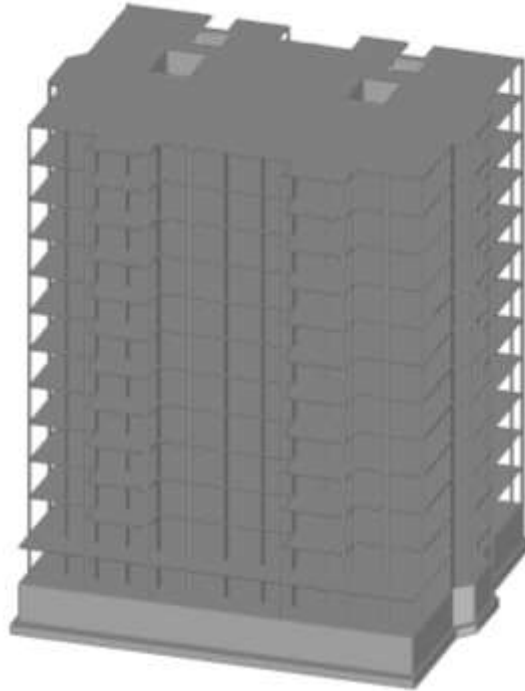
Розрахункова модель багатоповерхової будівлі
